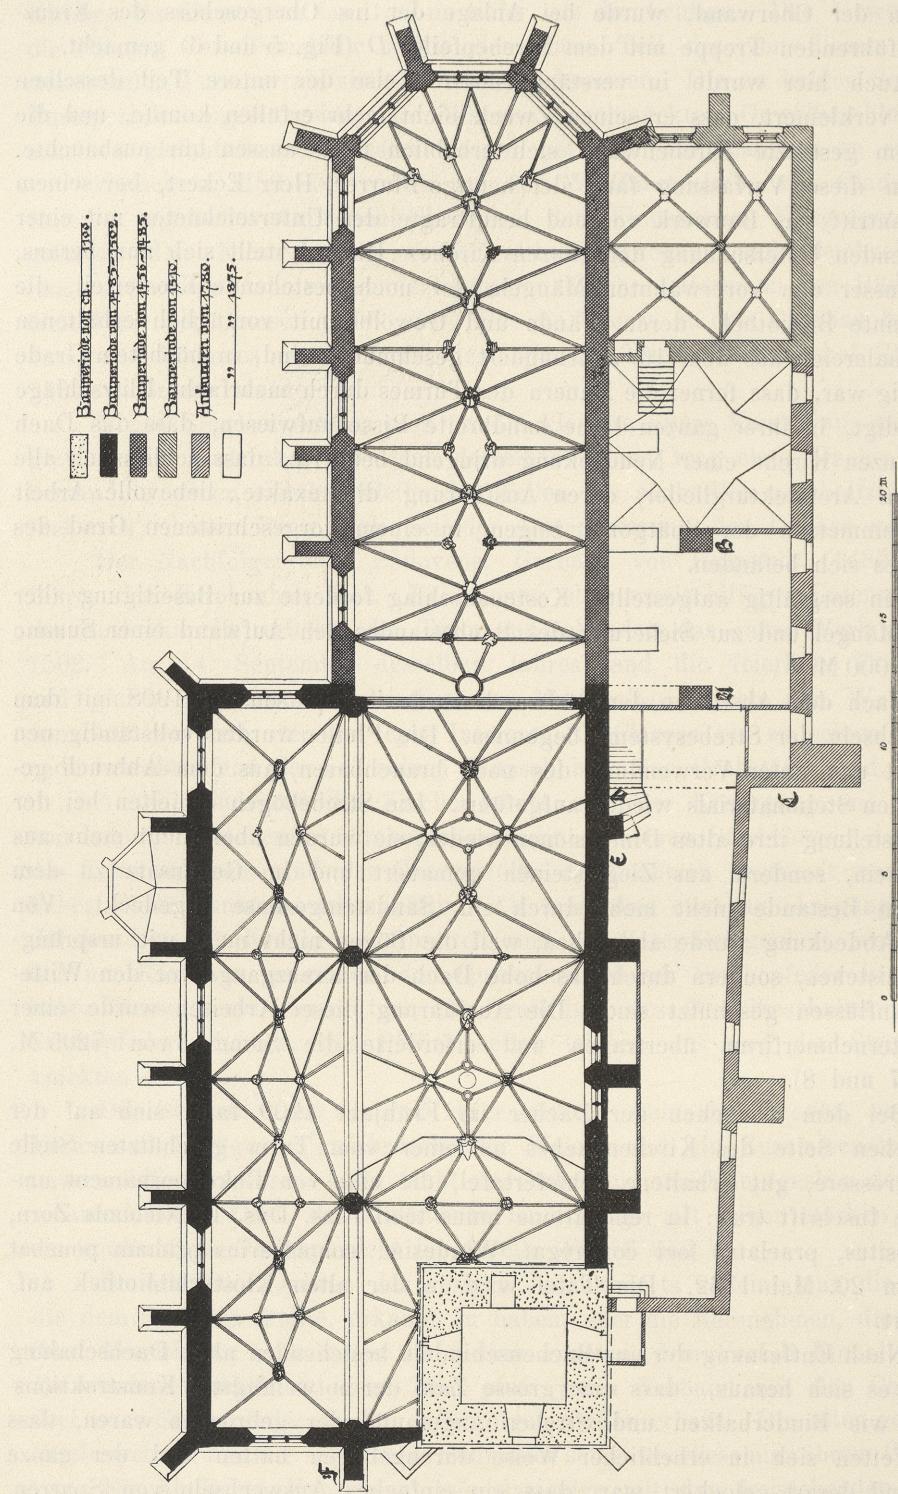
Clausen. Wallfahrtskirche. Oberer Grundriss vor der Wiederherstellung.
